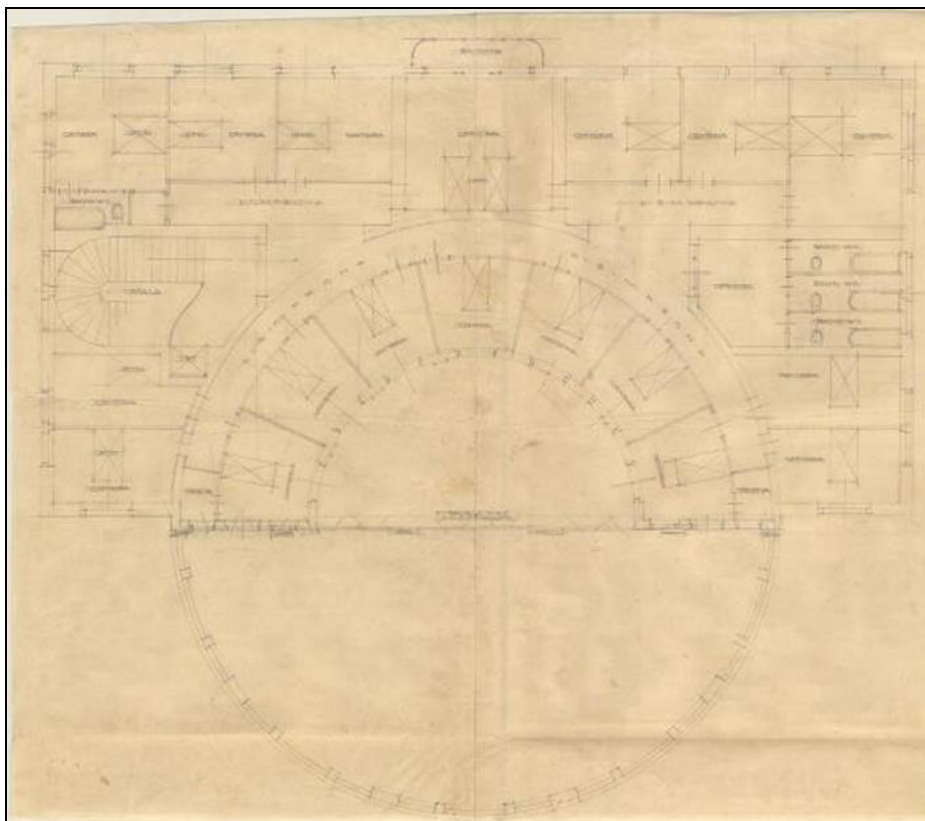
Piante del complesso – Archivio di Stato di Terni (Fondo Bazzani)
